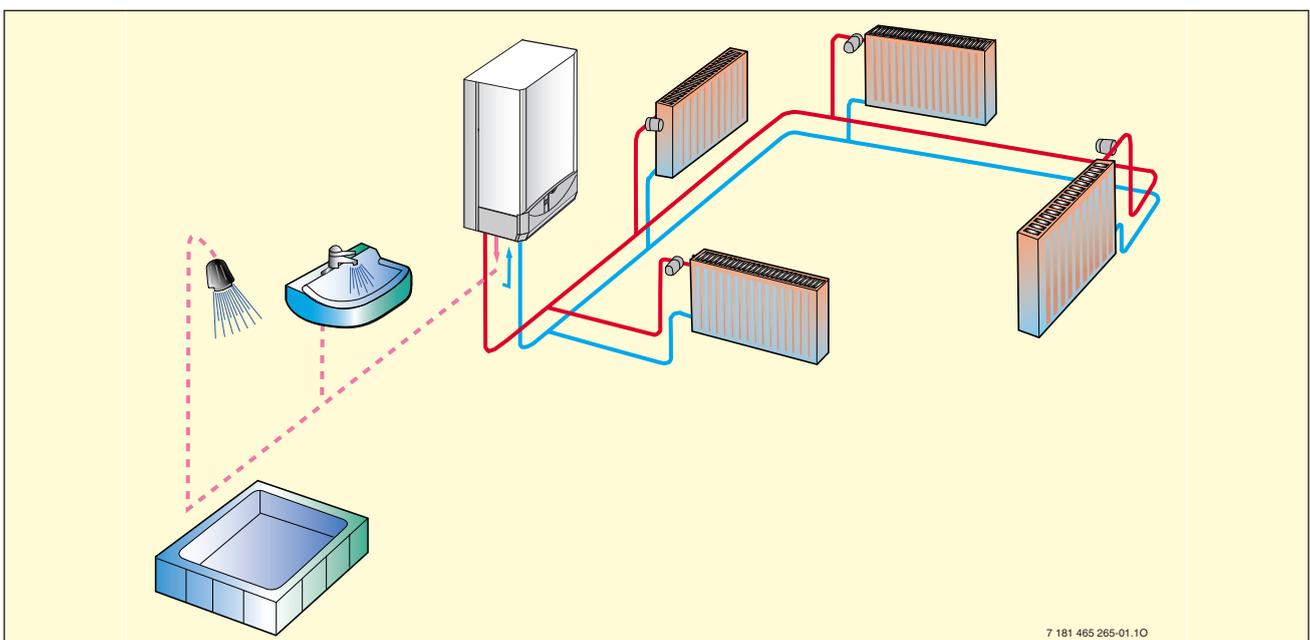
Anschlussschema ZWN 18/24-6 AME mit 2-Rohr-Heizung und Warmwasseranschluss
